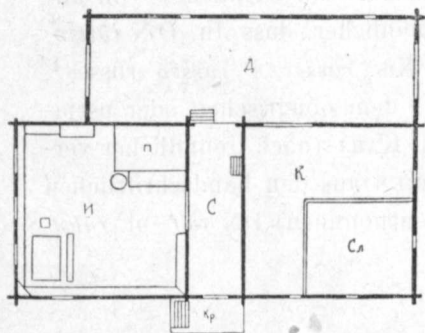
Grundriss eines tverischen gehöftes. Nach Artamonov.
